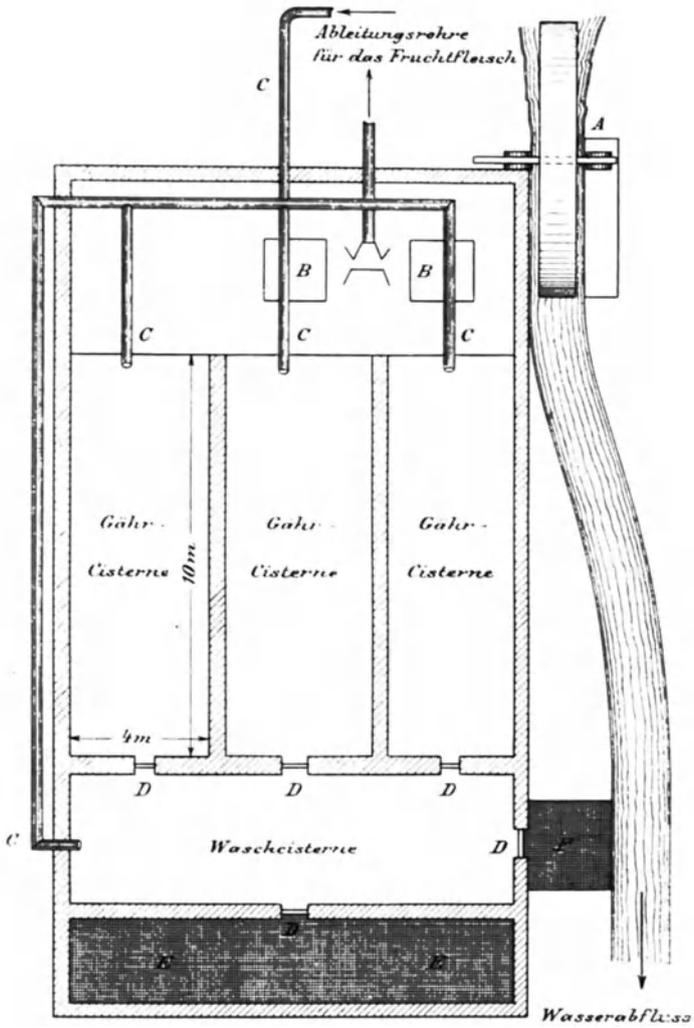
Grundriß einer Kaffeebereitungsanstalt.
